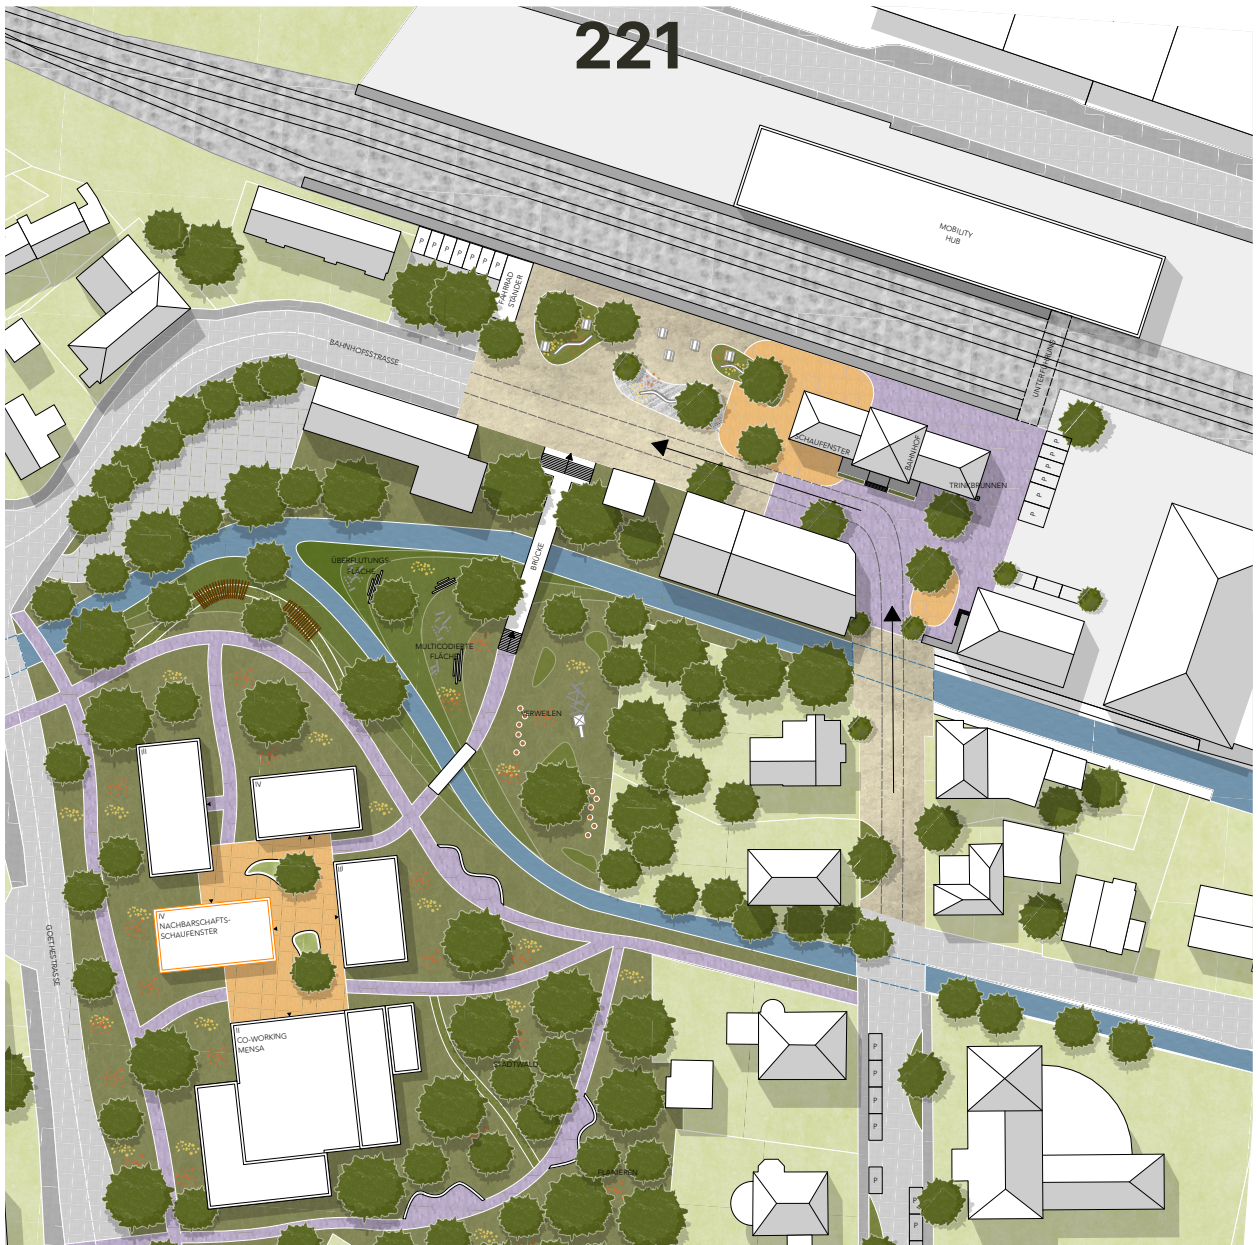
Übermorgen – Lageplan zum Bahnhofsbereich
